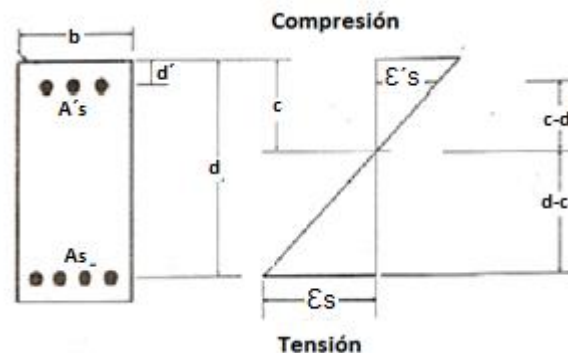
Comportamiento flexionante en la sección de vigas de concreto reforzado.
